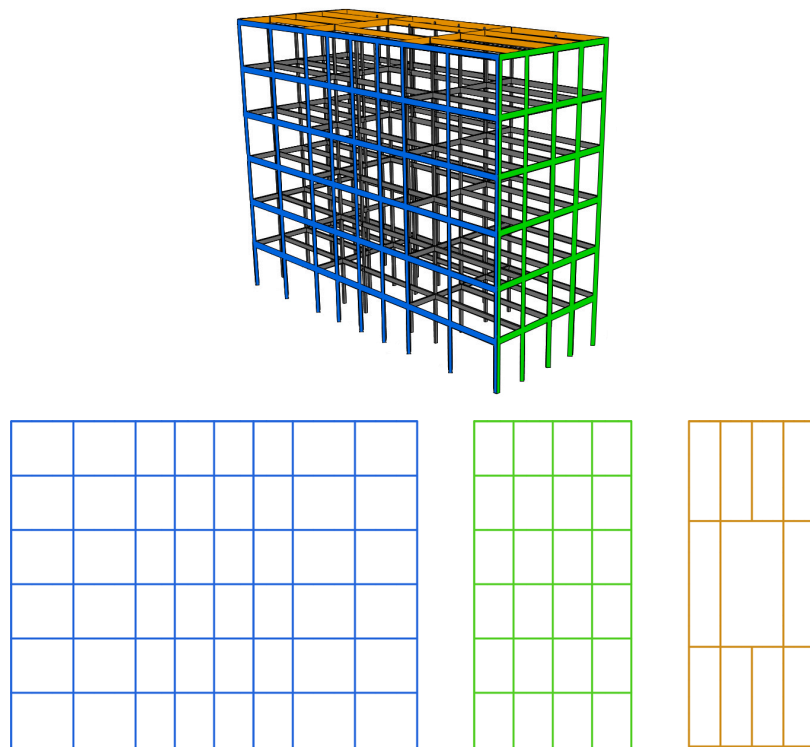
Vistas de Mod1: arriba se muestra la vista 3D; abajo se muestran los alzados, fachada oeste en azul y fachada sur en verde; y la planta en naranja.
